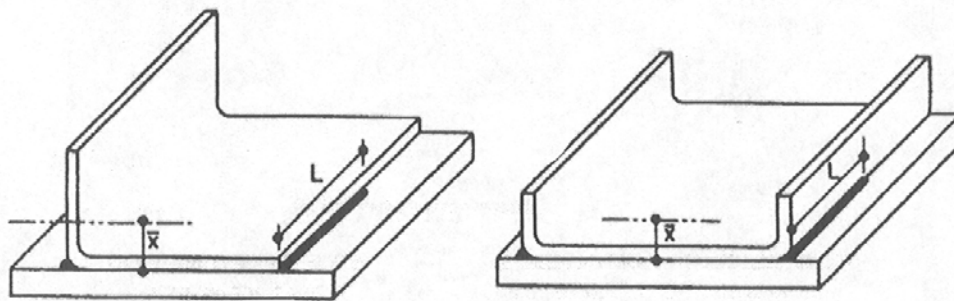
Definición de \bar{X} y L para soldaduras
